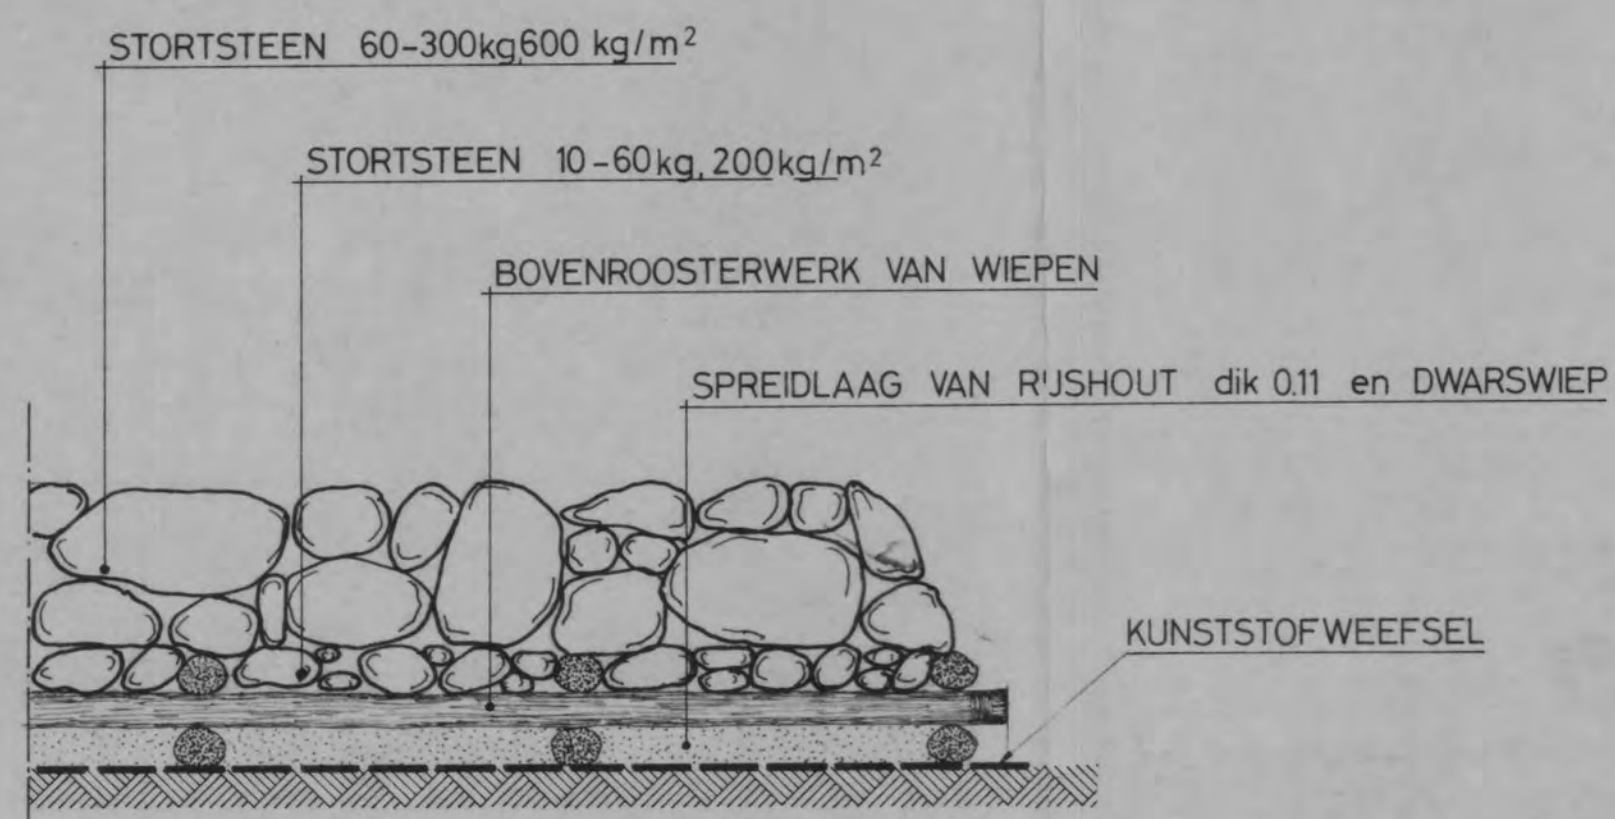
DETAIL C' = DETAIL C DOCH MIJNSTEEN VERVANGEN DOOR SLAKKEN/MIJNSTEEN
